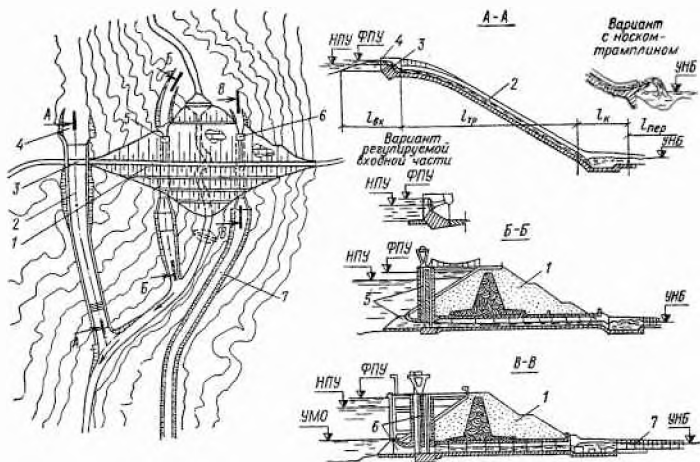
Схема гидроузла с плотиной из грунтовых материалов и береговым открытым водосбросом
